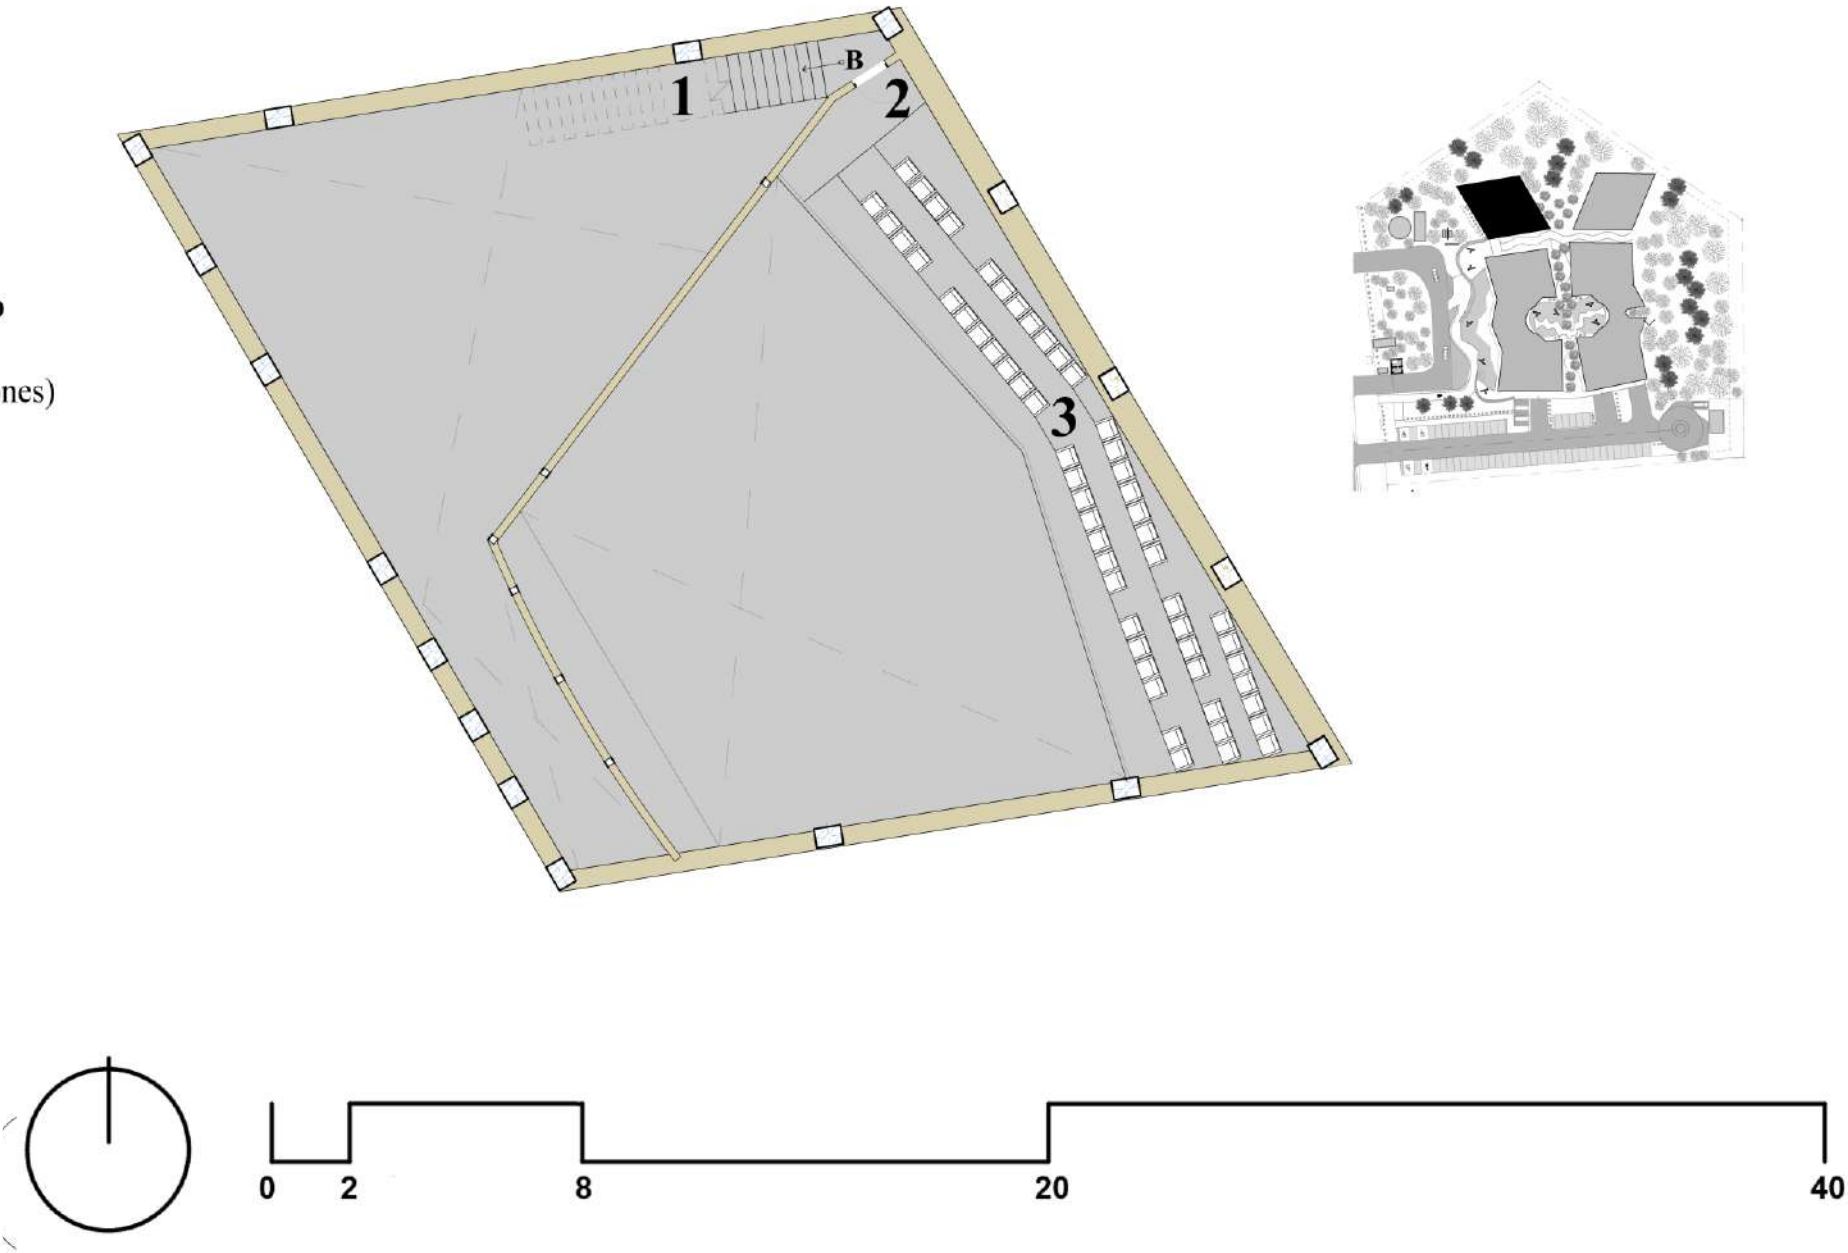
Planta Arquitectónica de nivel 01, edificio C, elaborado por autor, 2024.
